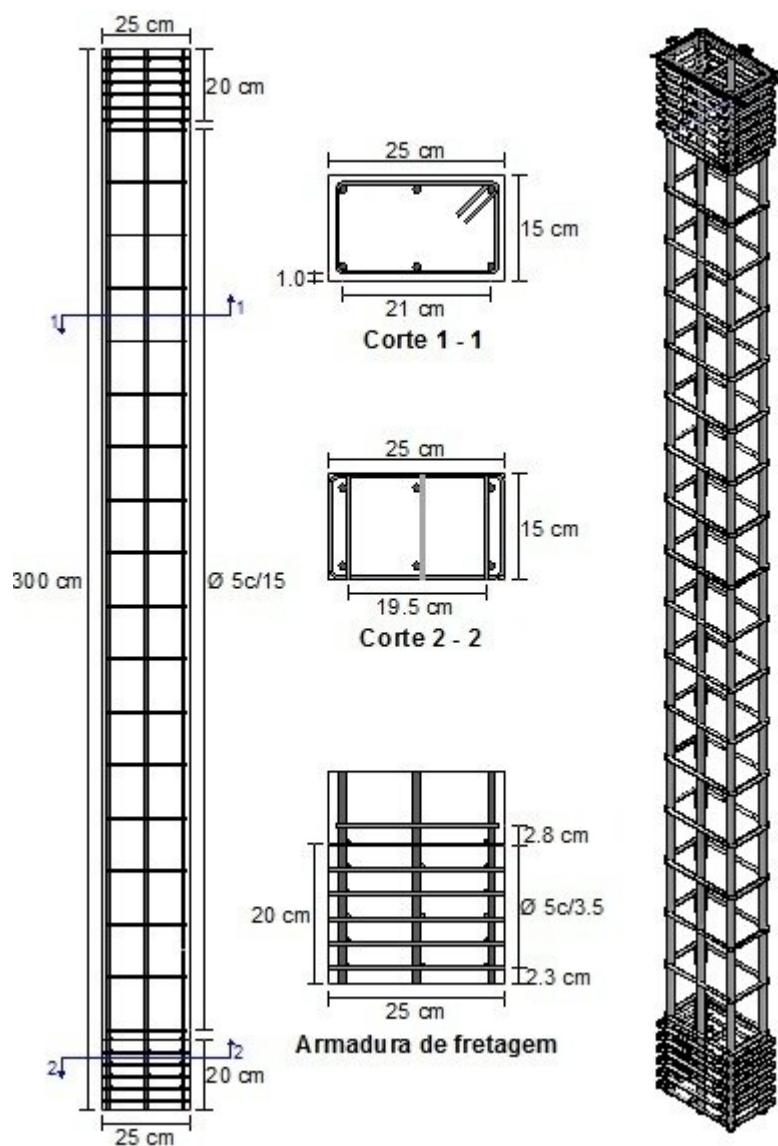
Detalhamento das armaduras dos pilares C40-1.3 e C80-1.3
